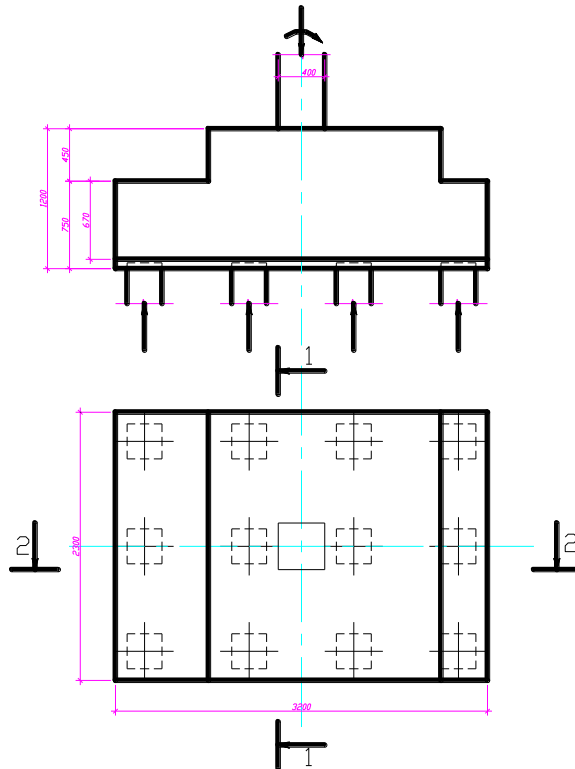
Расчетная схема для определения арматуры подошвы ростверка
